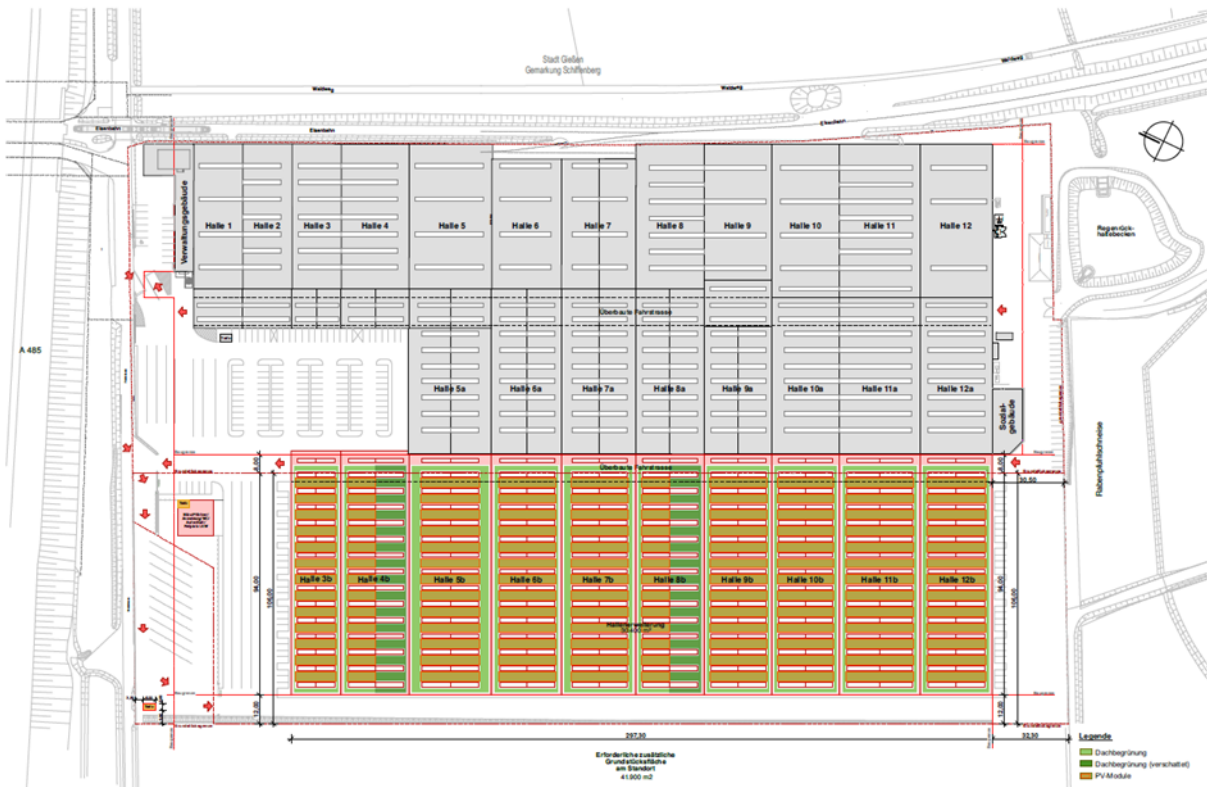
Erweiterungsplanung - Grundriss, unmaßstäblich verkleinert
